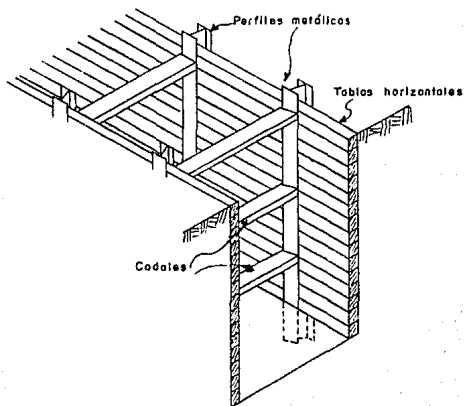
Ademe horizontal sostenido por perfiles metálicos
